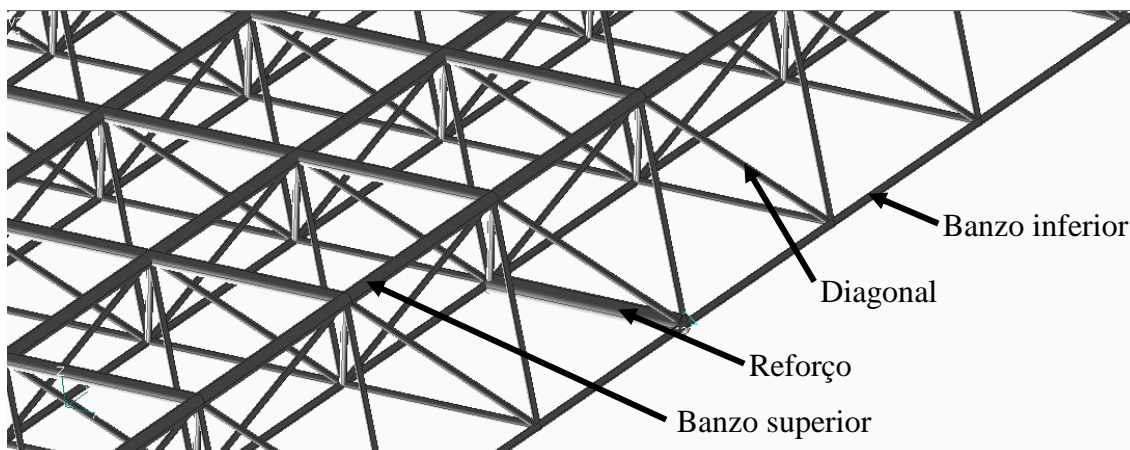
Arranjo estrutural treliça tridimensional módulo 50 x 10
